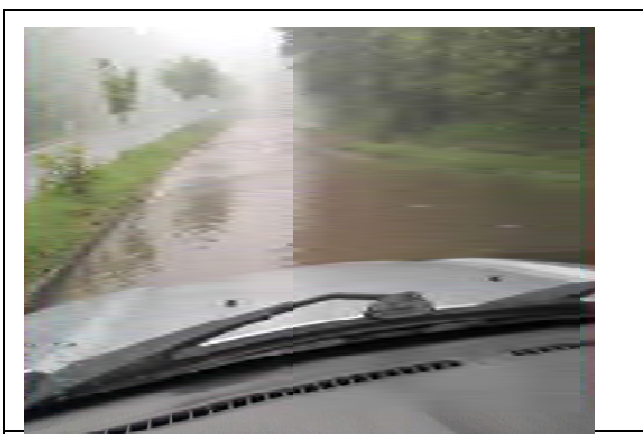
Ciudad Santa Tecla, situación de inundación de Boulevard Sur (Octubre, 2011)
